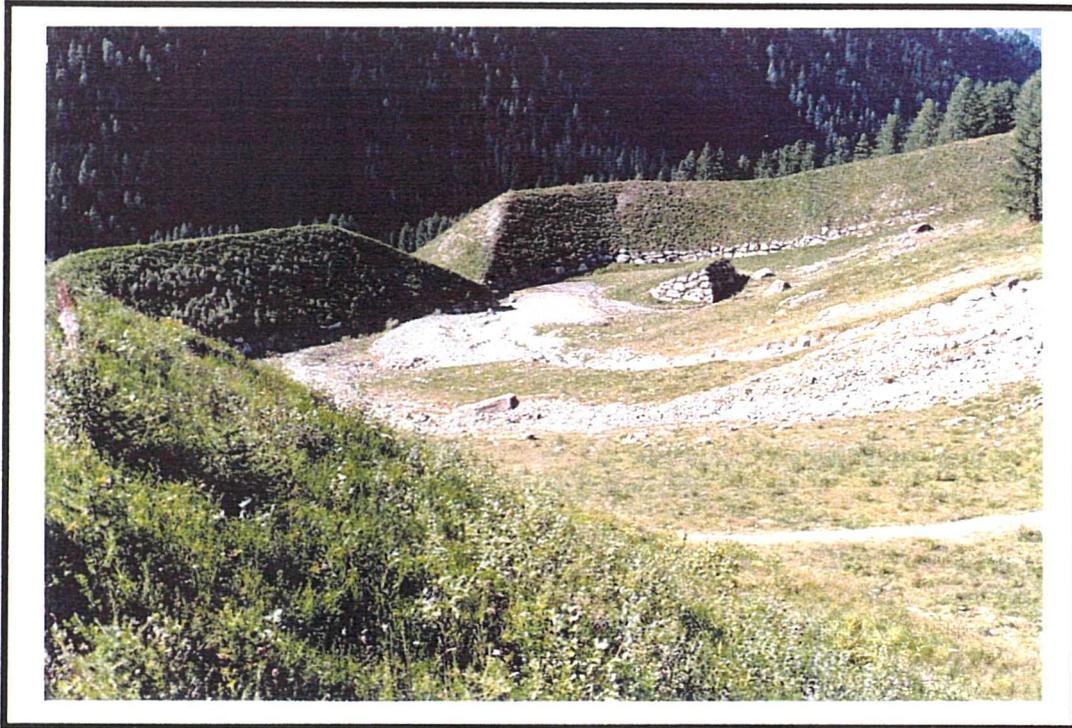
Enorme digue de protection à l'entrée du village de Zinal, sur le torrent de Perrec.
